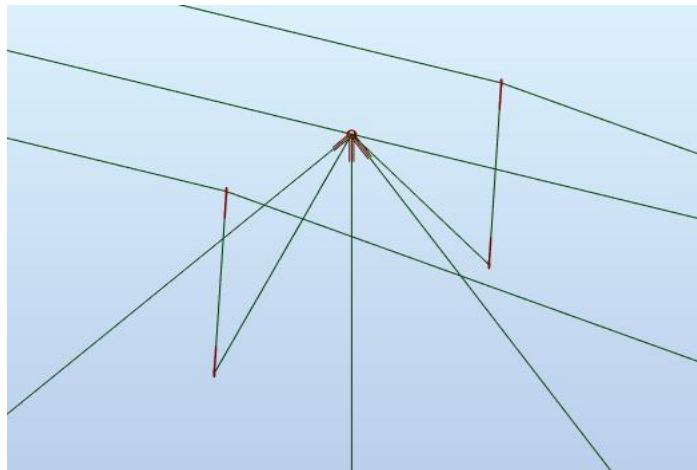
Pormenor de um dos dois elementos de ligação intermédia entre a treliça e o tubo pressurizado
